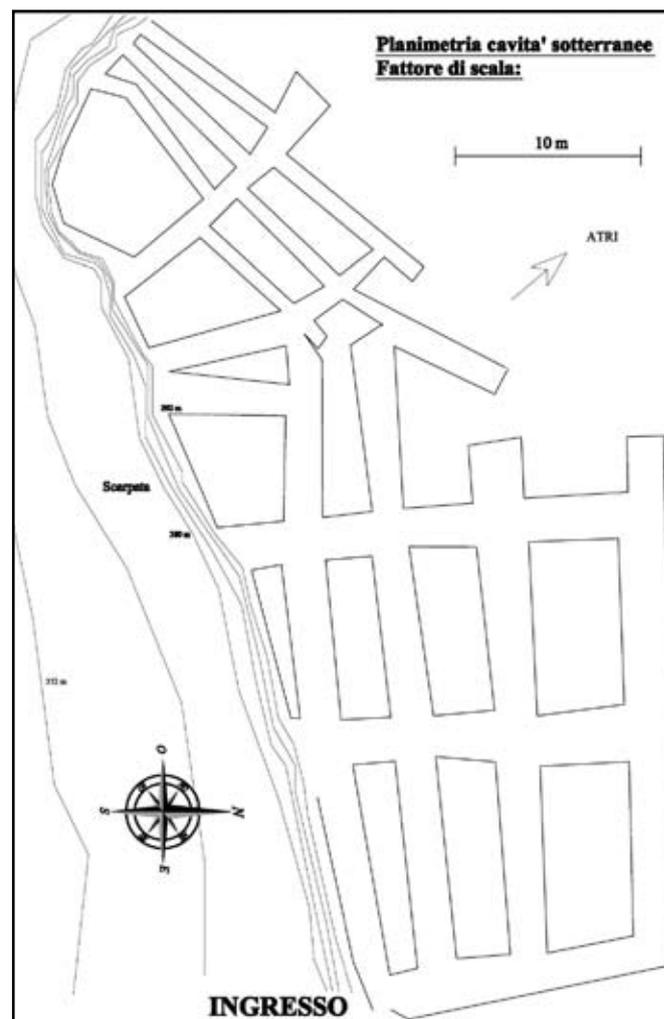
Atri: planimetria "Le Grotte" (grafica P. Pagliara).
